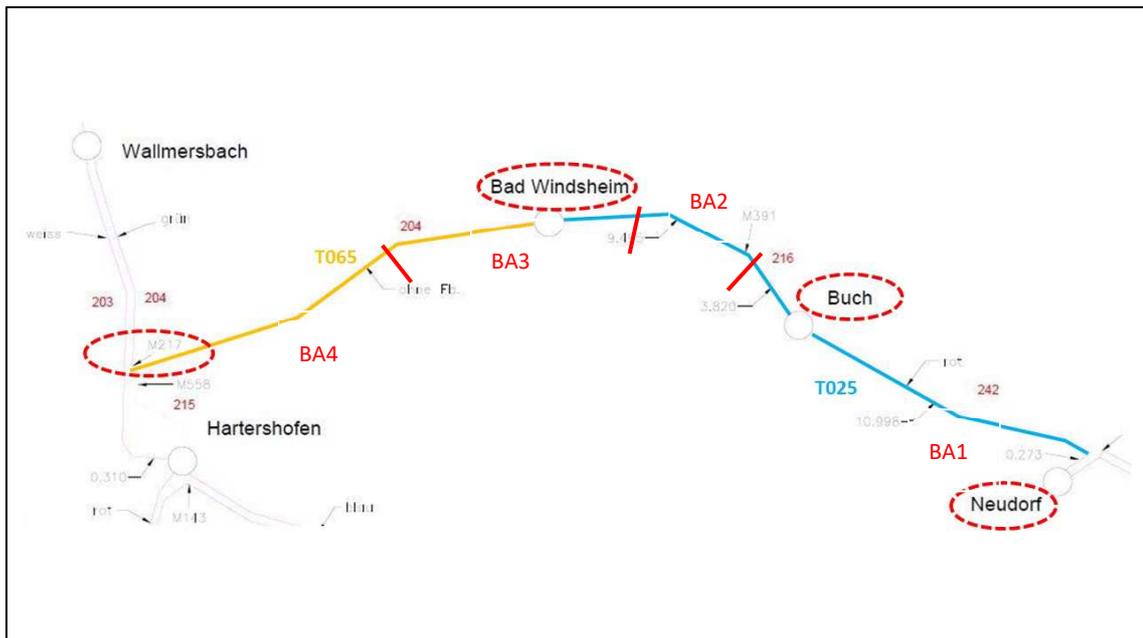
Lageplan T025-T065 mit Umspannwerken und Bauabschnitten
